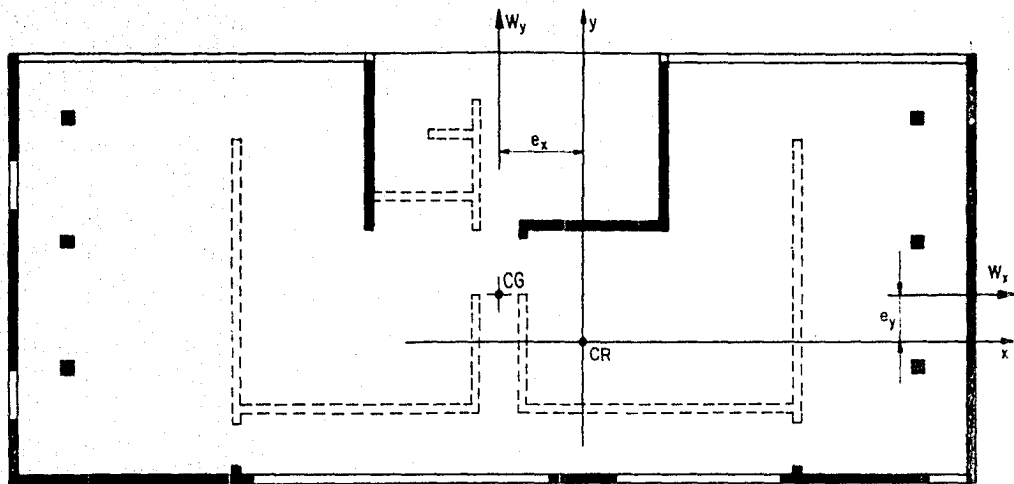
Estructuración utilizando varios tipos de modelos estructurales.
